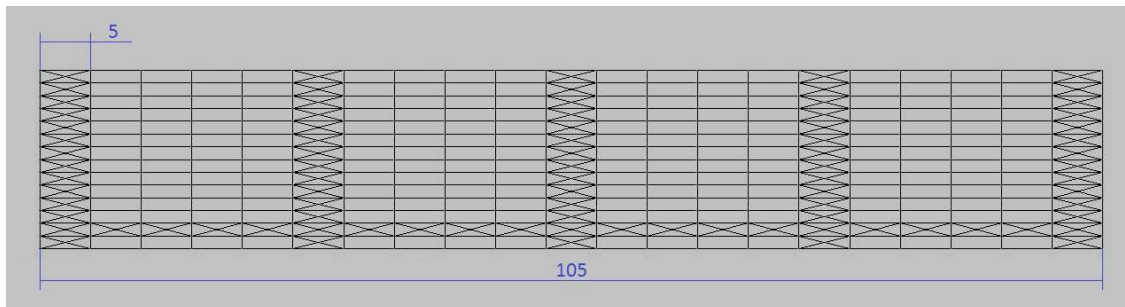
Techo de la cubierta metálica (dimensiones en m)
